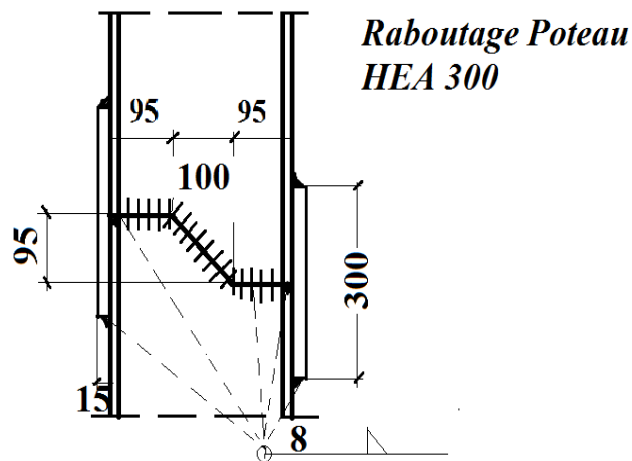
Assemblage poteau HEA300 - poteau HEA300(Raboutage)
